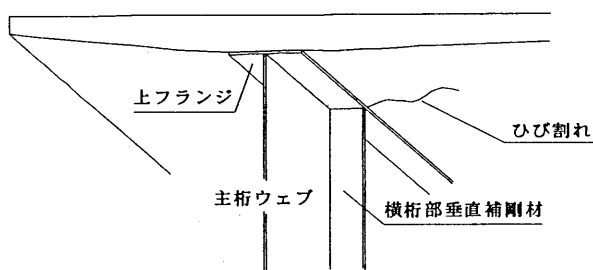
横桁付近の床版下面のひび割れ
